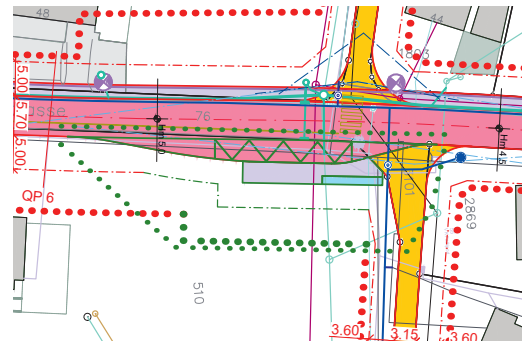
Ausschnitt Überbauungsplan Änderung - Neuer Zustand
